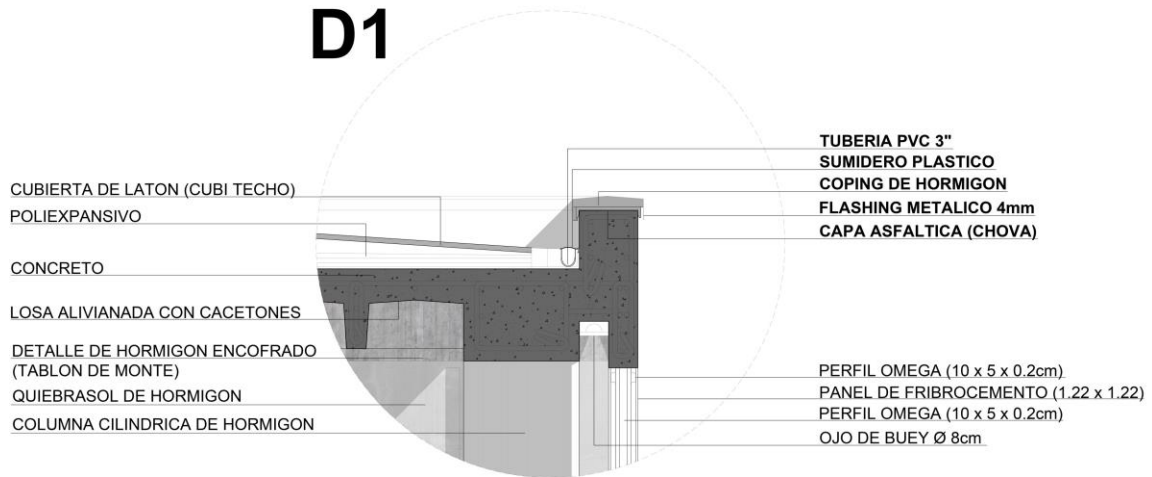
Detalle 1. Corte por fachada 2. Elaboración propia.
